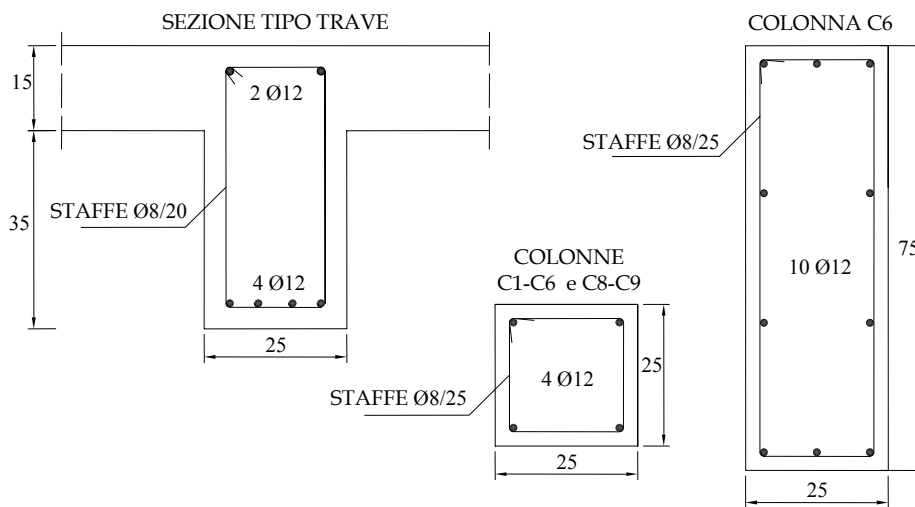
Sezioni tipo delle travi e dei pilastri (dimensioni in *cm*)
